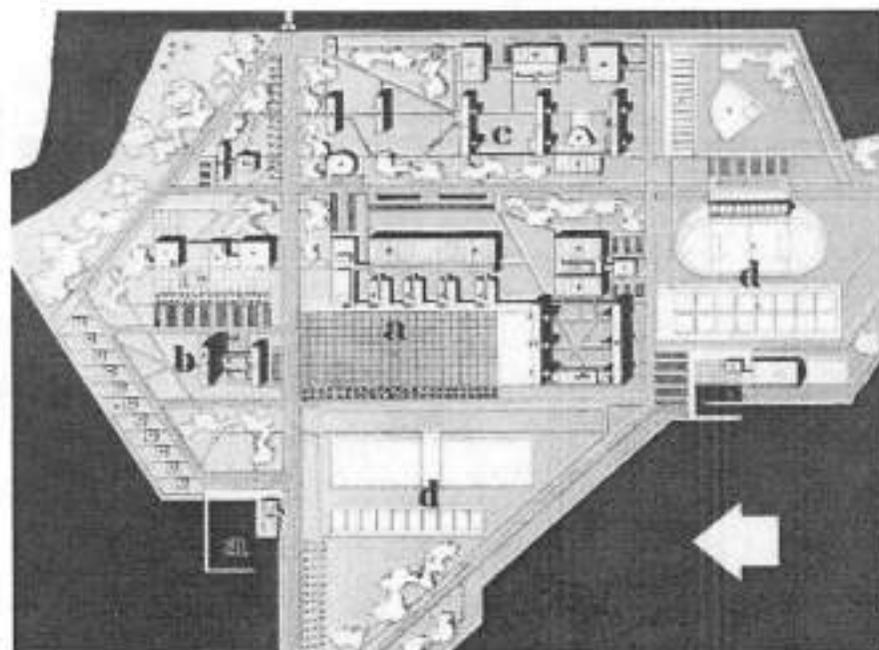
Plan Piloto original Obregón & Valenzuela:
